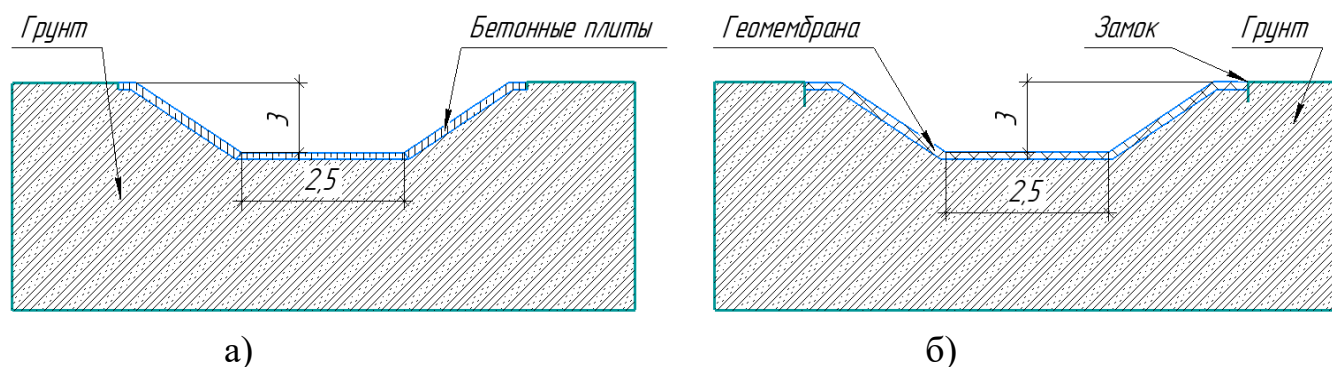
Схемы укладки а) - бетонных плит, б) – композитного материала
